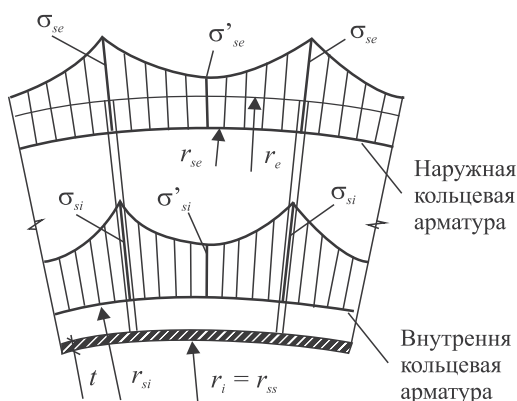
Эпюры напряжений в кольцевой арматуре сталежелезобетонного водовода
